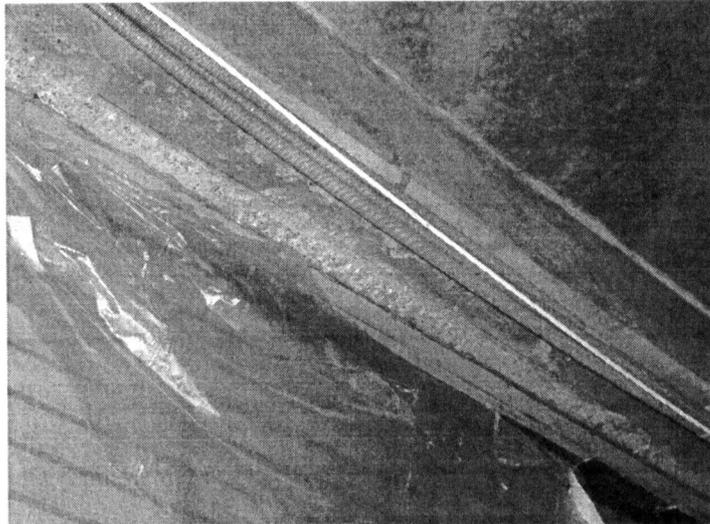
Fugendichtmasse im Deckenhohlraum; Anschluss Klinkerwand an Betonunterzug
